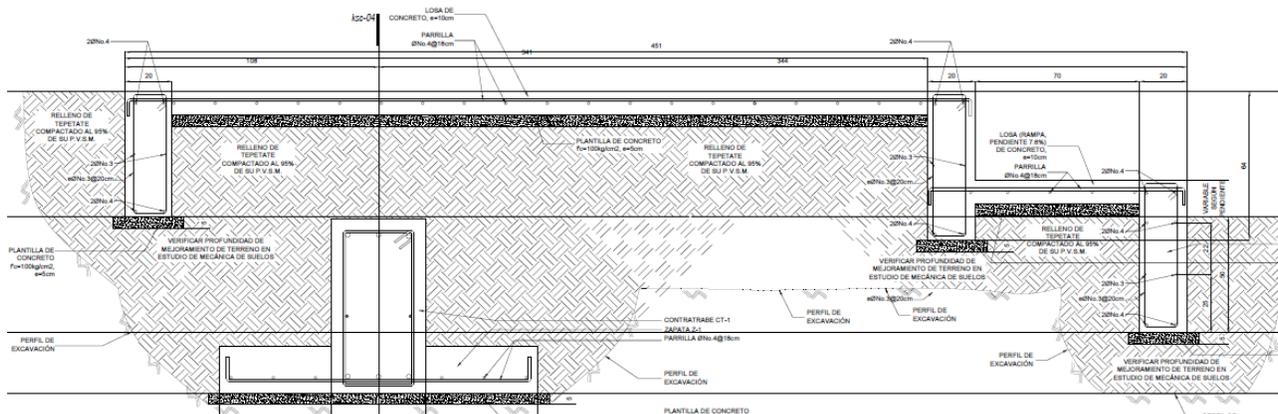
Detalle estructural de la conformación de la cimentación del Pabellón del Peñón. (Archivo Personal)
